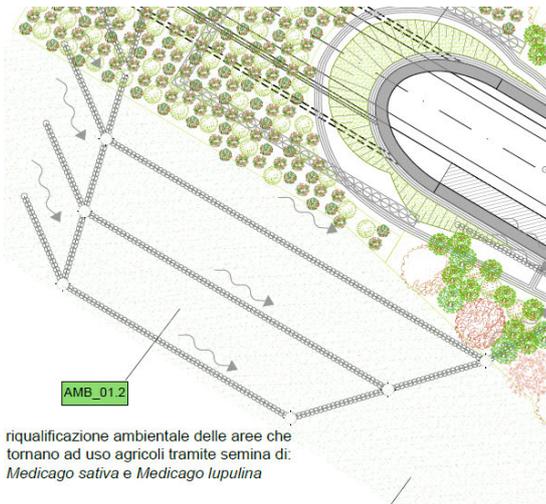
Estratti dalla planimetria interventi di mitigazione (T00IA07AMBDC02_B)
